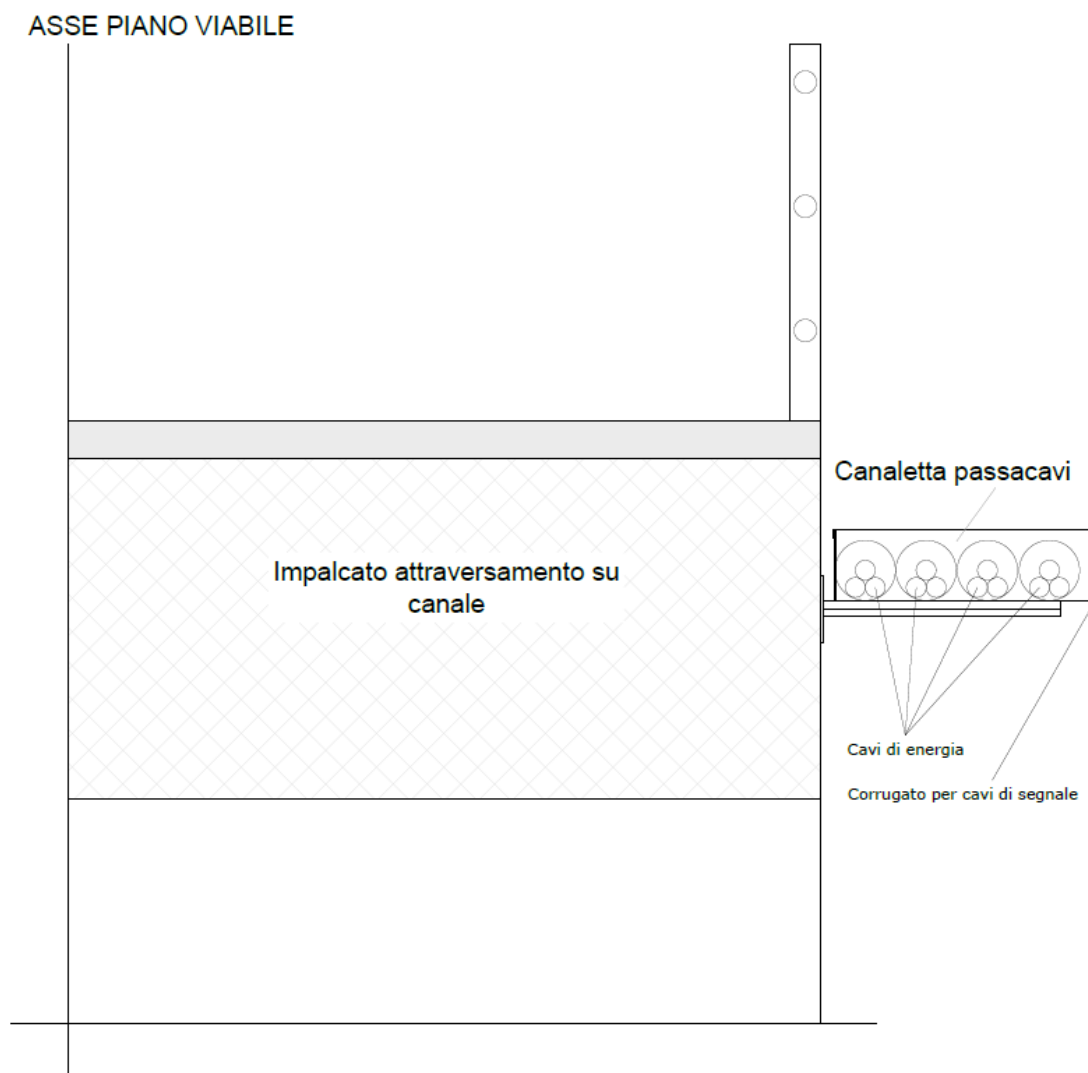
Sezione tipo posa in canaletta in fiancheggiamento al ponte esistente
